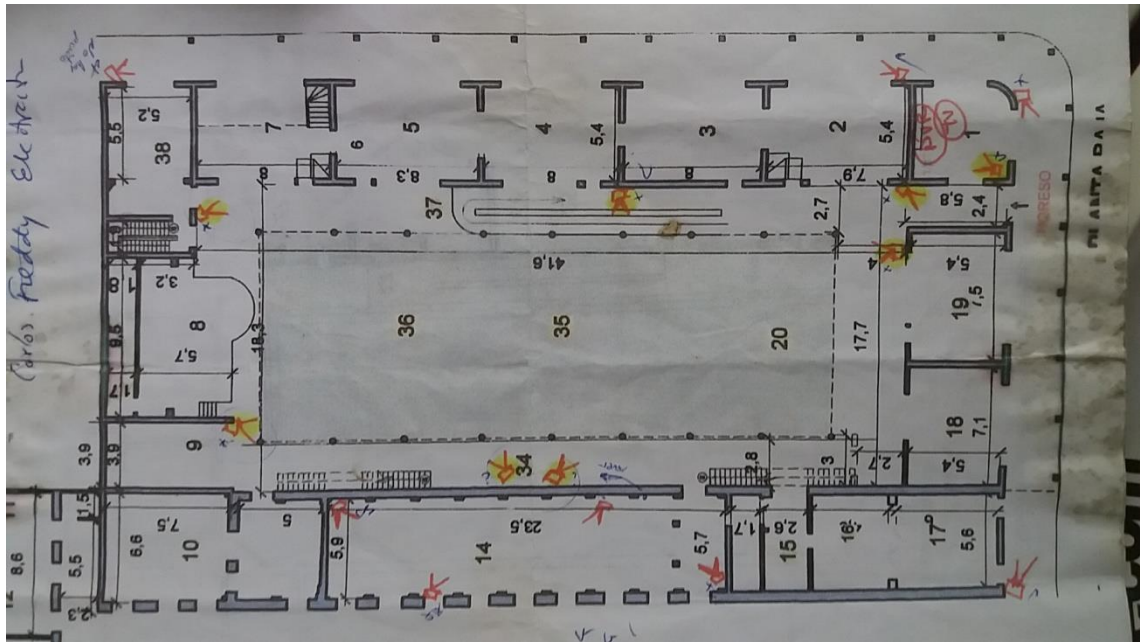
Plano con cámaras señaladas de la Feria Exposición CasaCor
